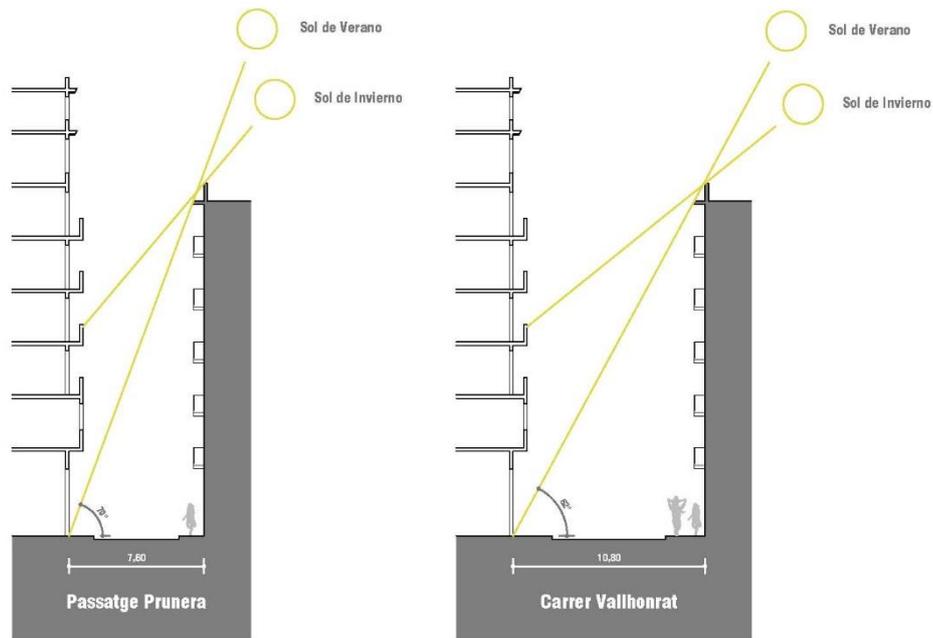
Secciones de las calles laterales del edificio. La poca distancia entre las fachadas a ambos lados de la calle no permite un correcto asoleo de la fachada. Fuente elaboración propia.
